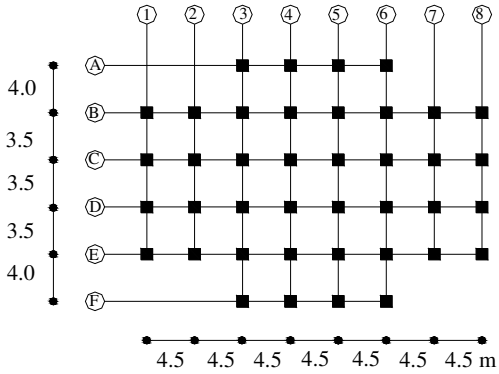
A3-4 Düzensizlik Durumu- Kat Planı
